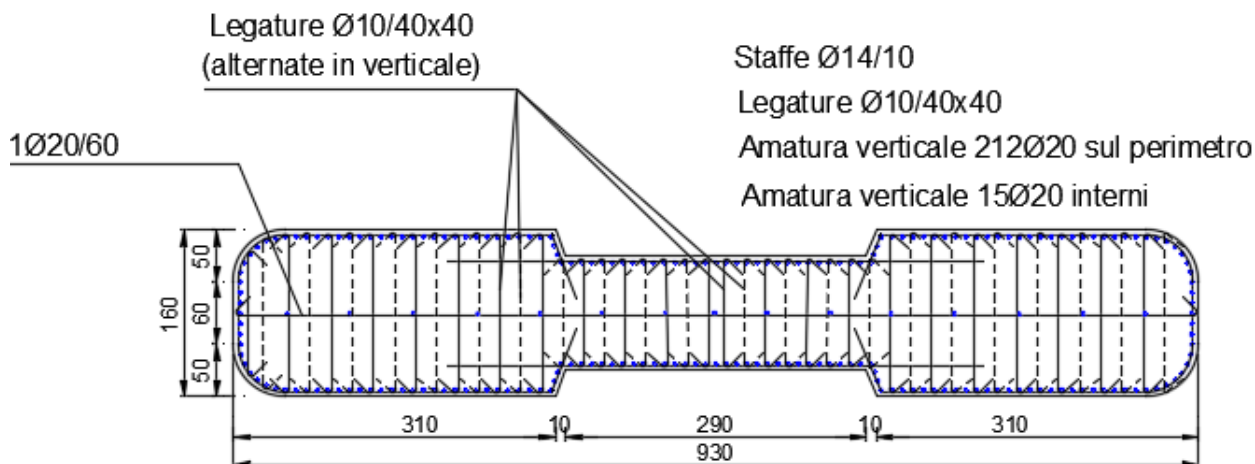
Dimensioni ed armatura pila 1 - pila 3 – pila 4
